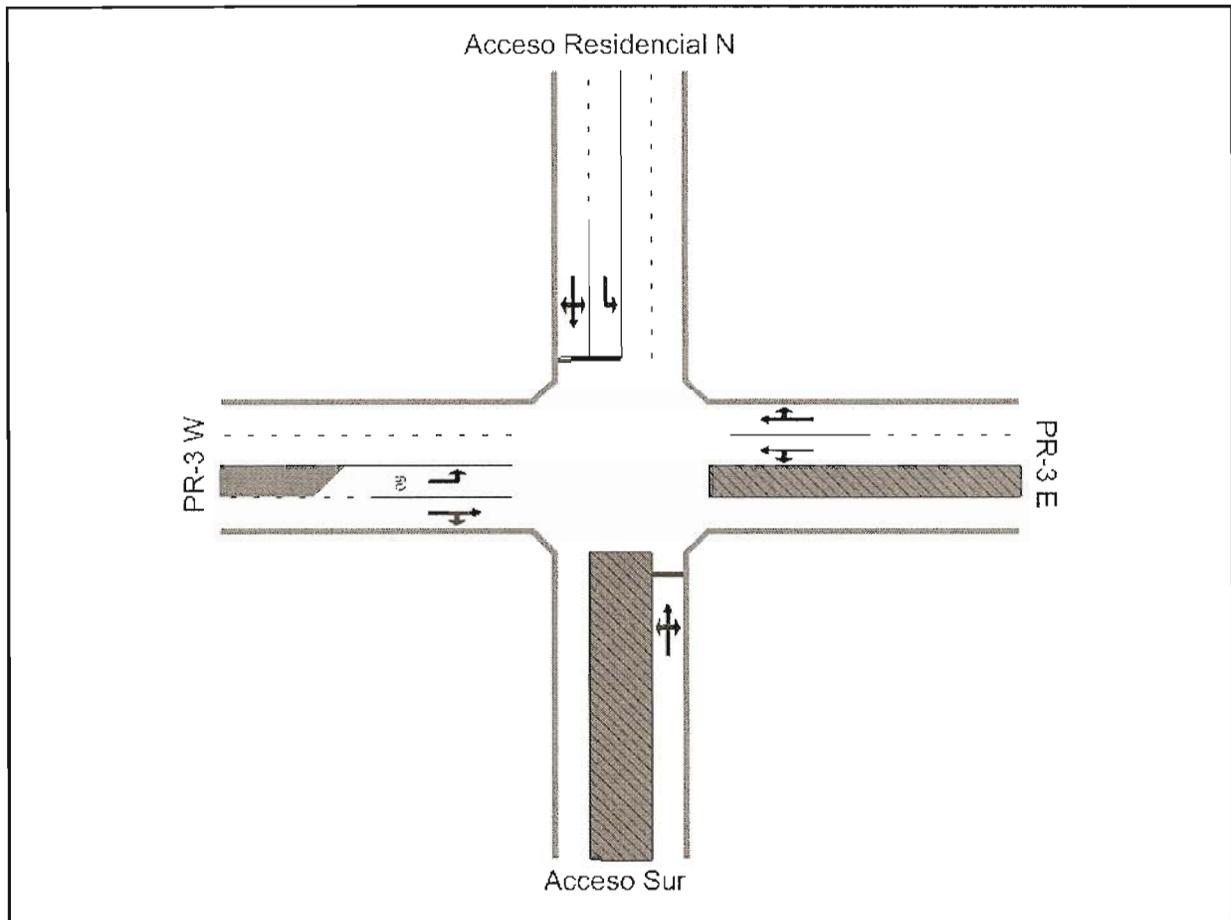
Int. PR-3 y Acceso Proyecto (Geometría Futuro)
